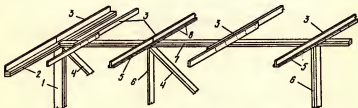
Схема укладки балок на верхнюю обвязку внутренней несущей стены:
